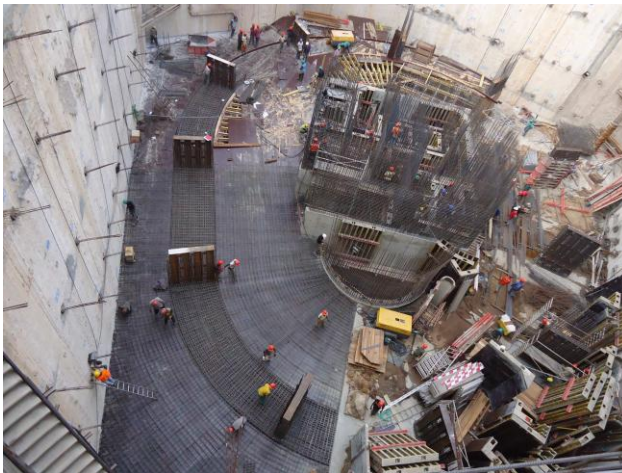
Fotografia: Vista Geral da Obra – Caves
